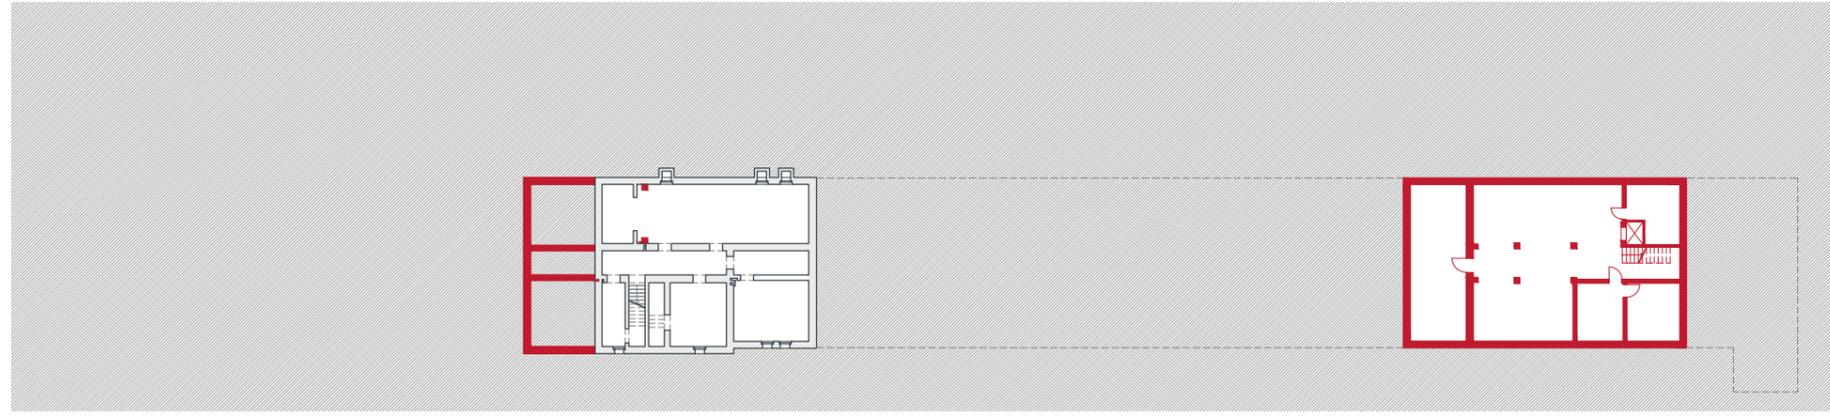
Zollamt und Zollschuppen: Kellergeschoss mit baulichen Veränderungen, 1904-2022 M 1:500
